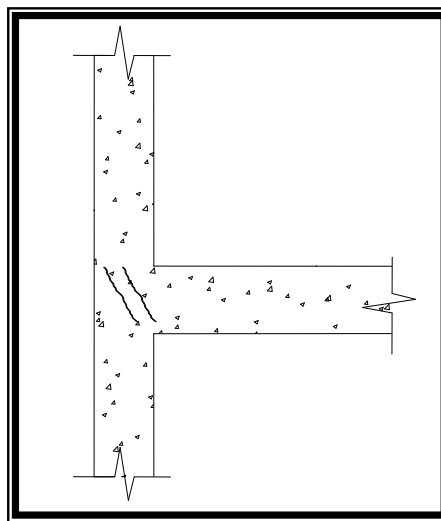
Grietas a 45° en la unión (Falla por corte)
